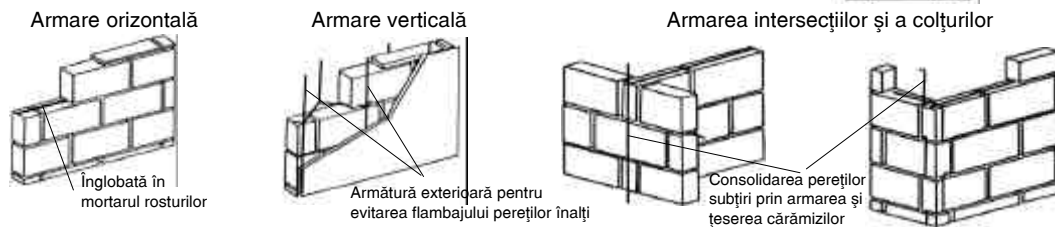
Zidărie de cărămidă armată. Armătură transversală și longitudinală. Armare interioară și exterioară. Armare pereți portanți și neportanți. Armare stâlpi.
